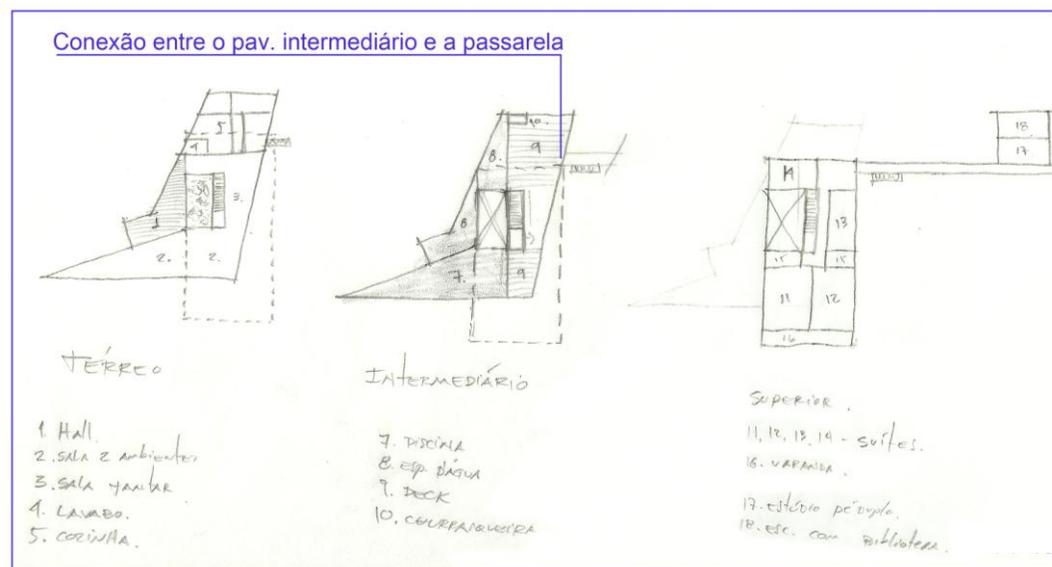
Plantas dos três pavimentos e a conexão entre o pavimento intermediário e a passarela
